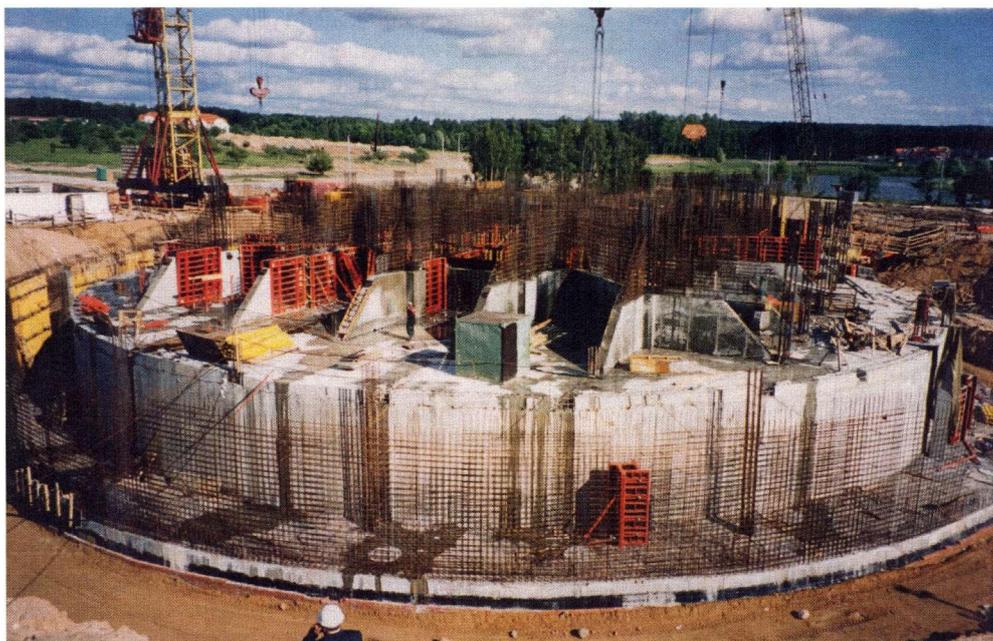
Внешний вид монолитного фундамента в процессе строительства
